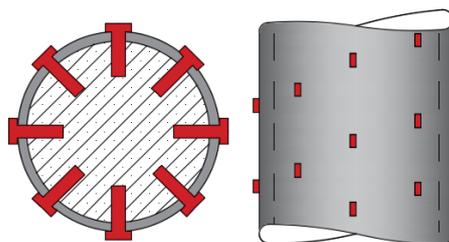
Устройство поперечных анкеров в трубобетонной колонне
